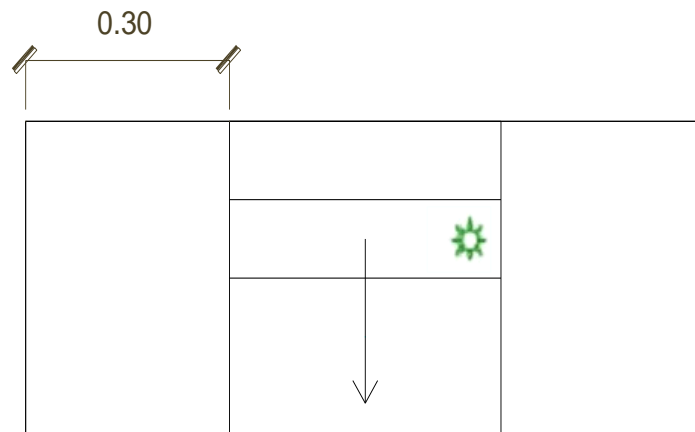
localização do ensaio VAF2H10Y30 (dimensões em metro)
